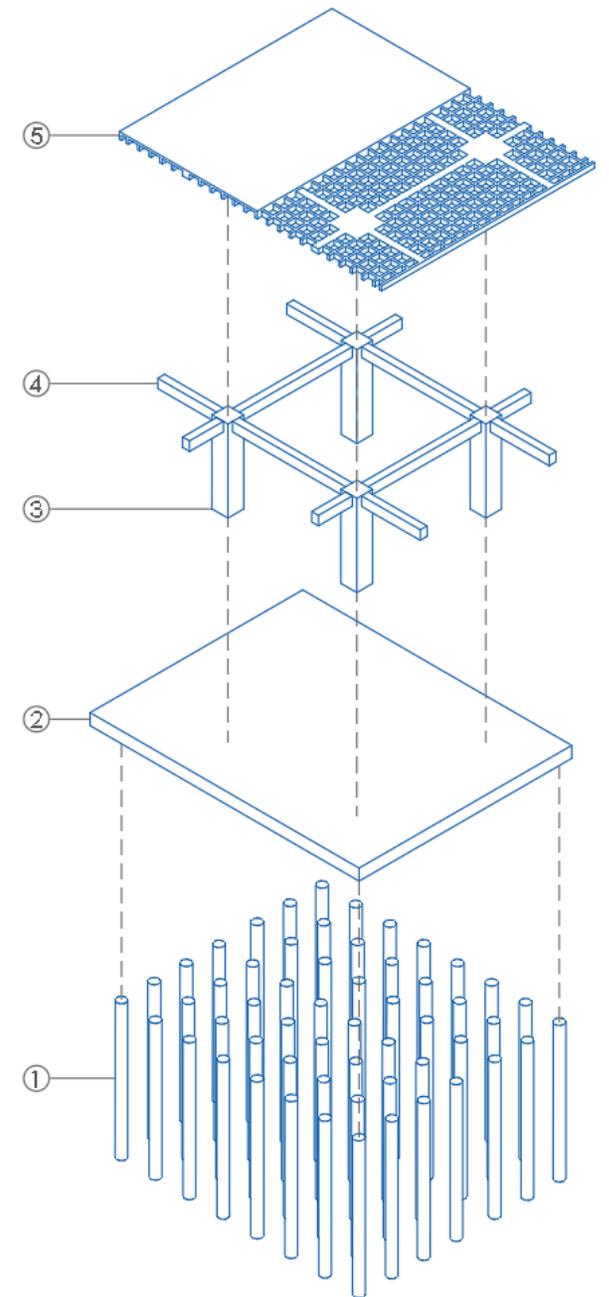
| Axonometría de sistema constructivo. Elaboración propia, 2021.
